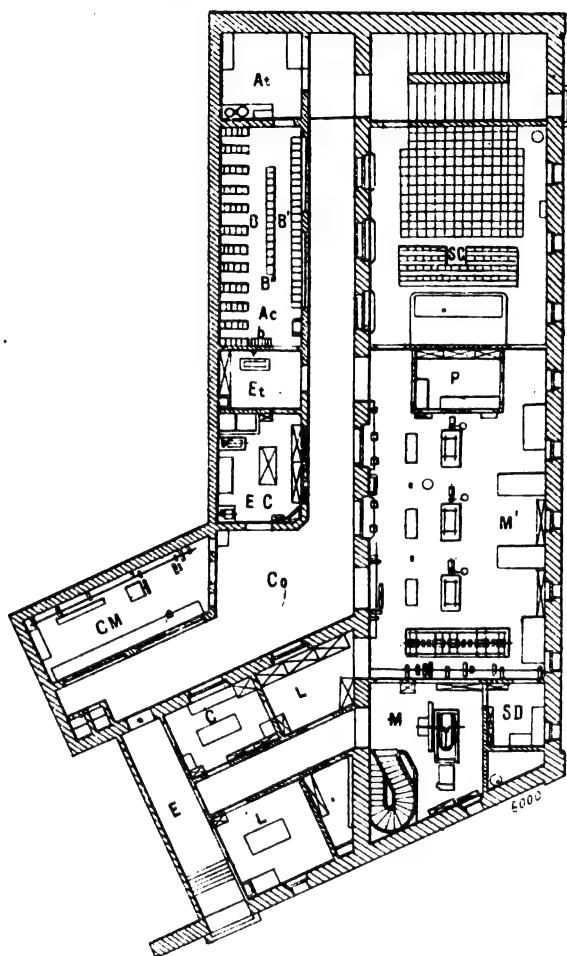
Plan du rez-de-chaussée de l'Institut Electrotechnique.
